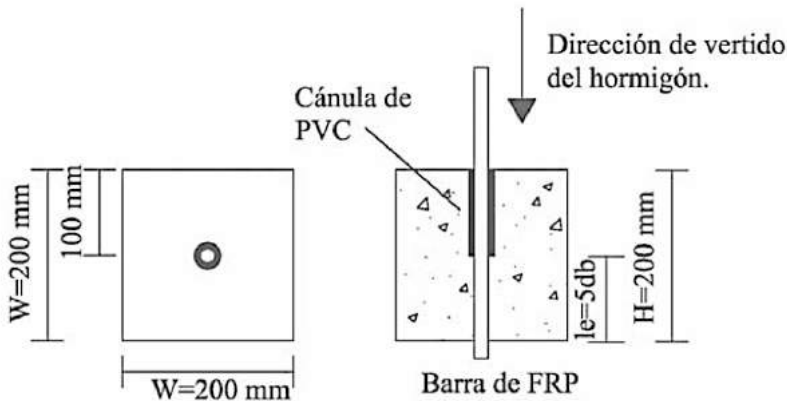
Ensayo de Pullout centrado. Dimensiones y características según ACI.440.3R-04.
